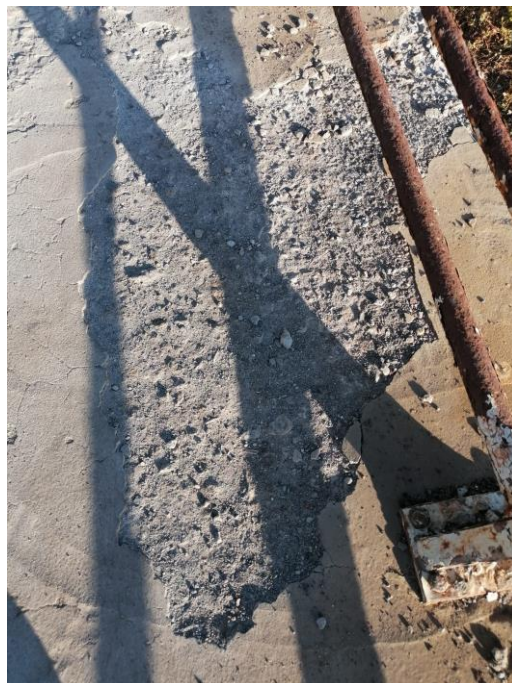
Avance del deterioro de la barandilla y del pavimento de hormigón
